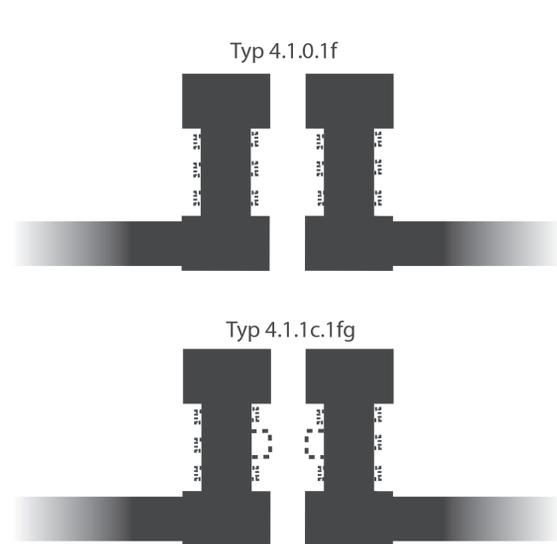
Auswahl möglicher Torgrundrisse des Typs 4
